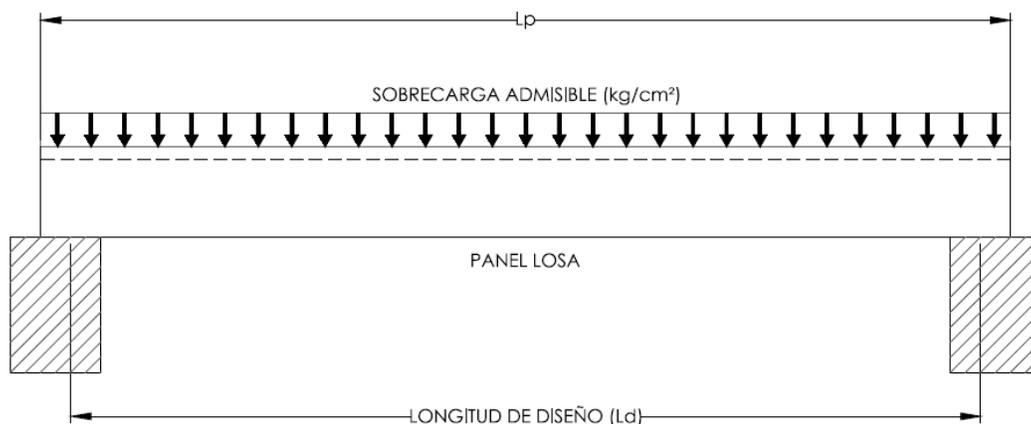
Esfuerzos sobre losas prefabricadas / Imagen de las fichas técnicas AICRET SMKT
